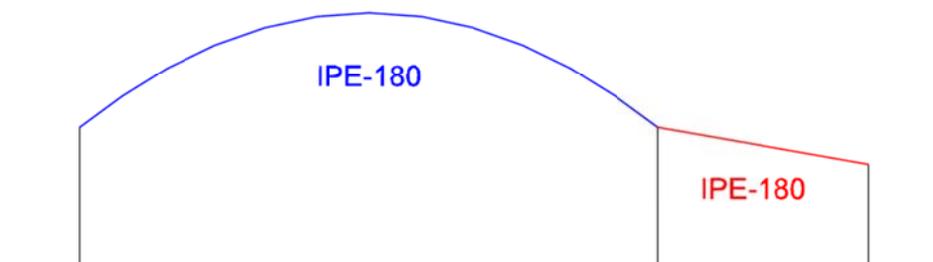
Predimensionado de las vigas de los pórticos extremos.
